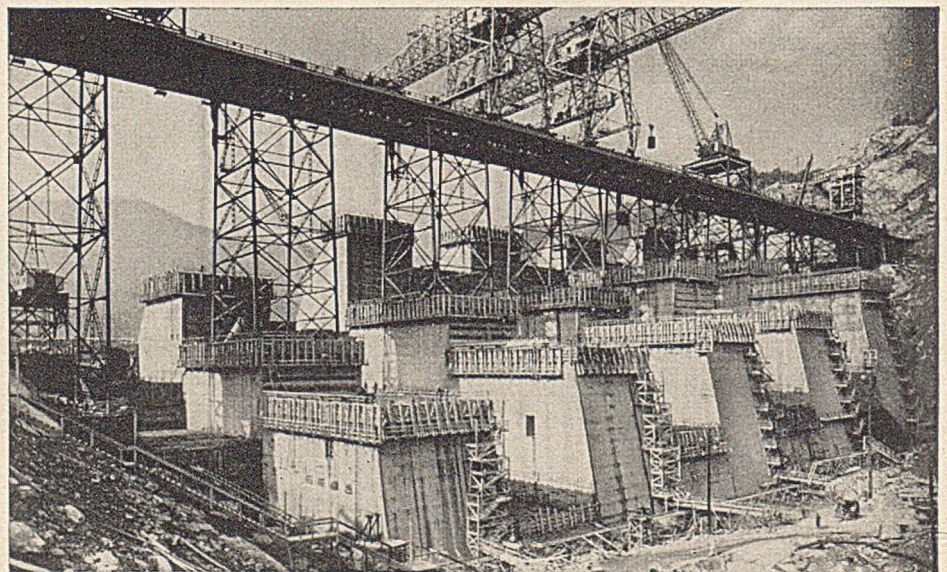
Fontana-Talsperre. Betonierungsbrücke und Portalkrane.
